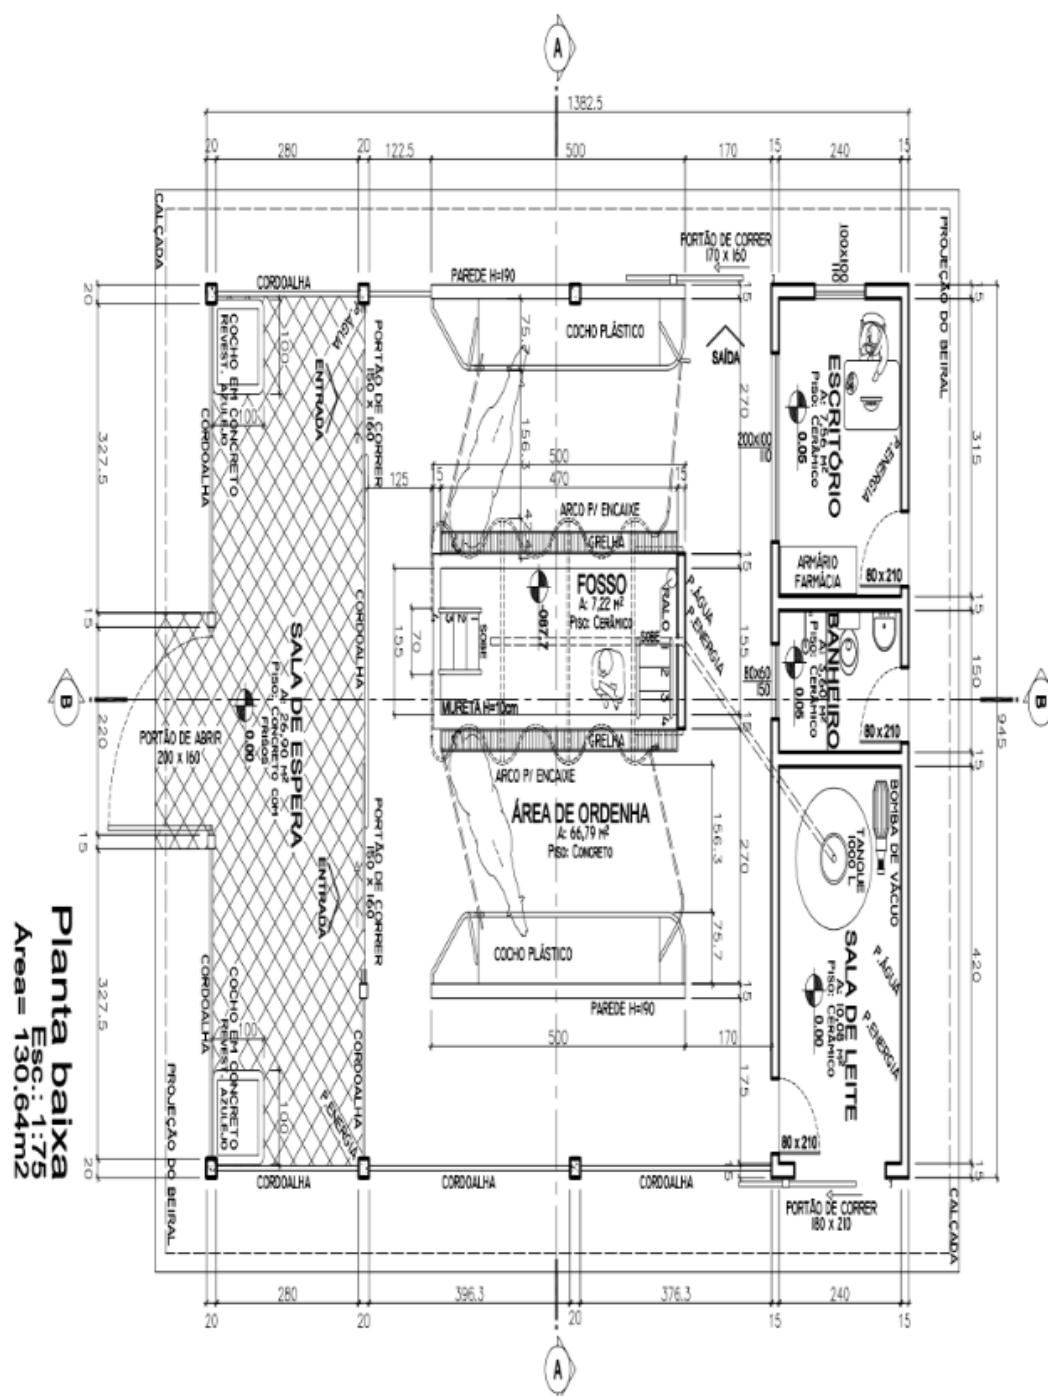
Planta baixa da instalação para a atividade leiteira. Fonte: Oliveira et al., (2018).
